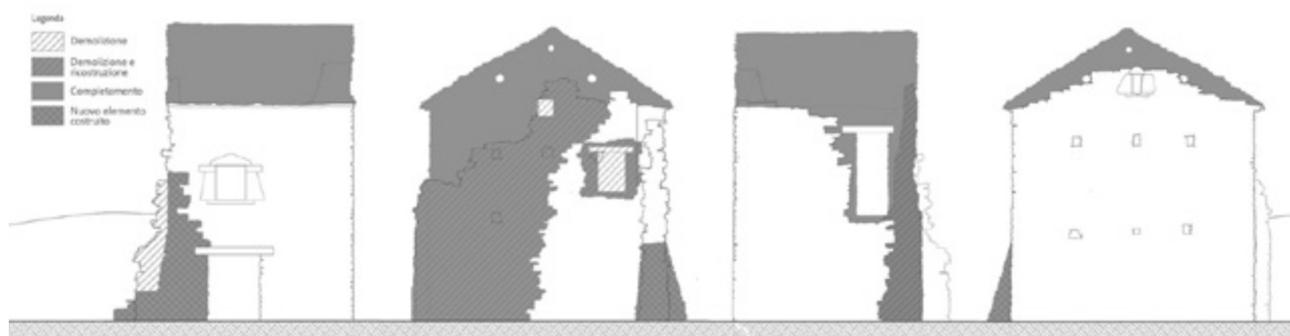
Da sinistra: interventi effettuati sull'esistente rispettivamente sul muro nord, ovest, sud ed est. © 2018, Rielaborazione degli autori.
